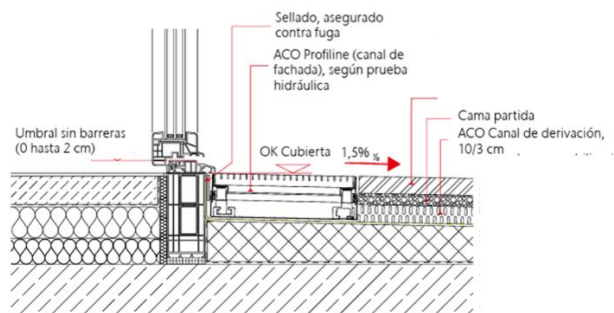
Detalle de canaleta de recogida de agua para la instalación de puerta de salida a la terraza a nivel.
